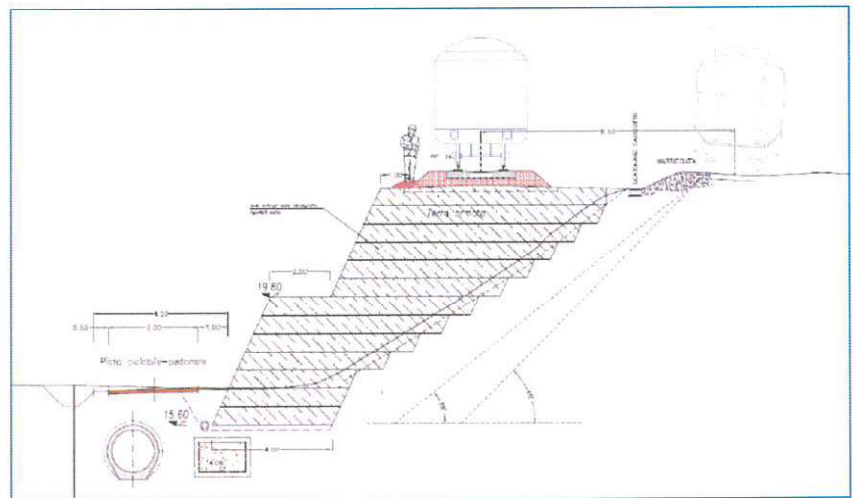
Sezione tipo dell'allargamento del rilevato FS esistente (cfr. tav. 8, allargamento asta di manovra, opere civili).
